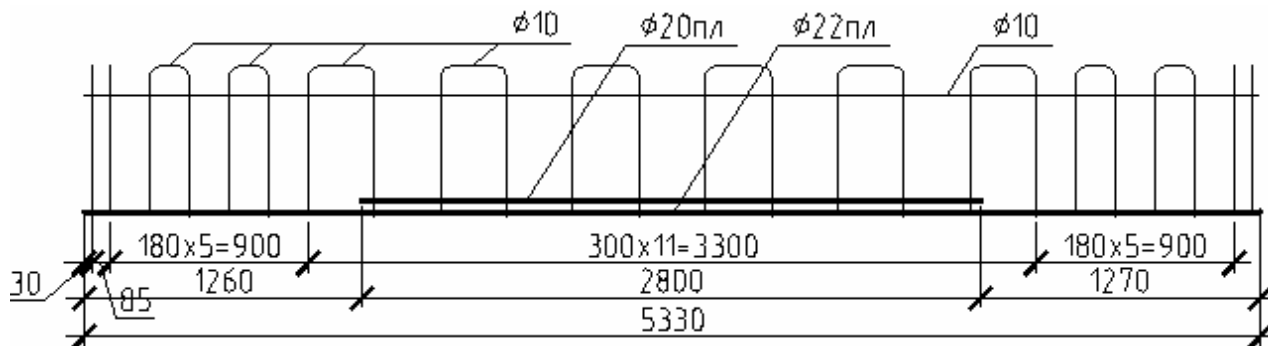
Схема армирования ригеля Р1–5.
